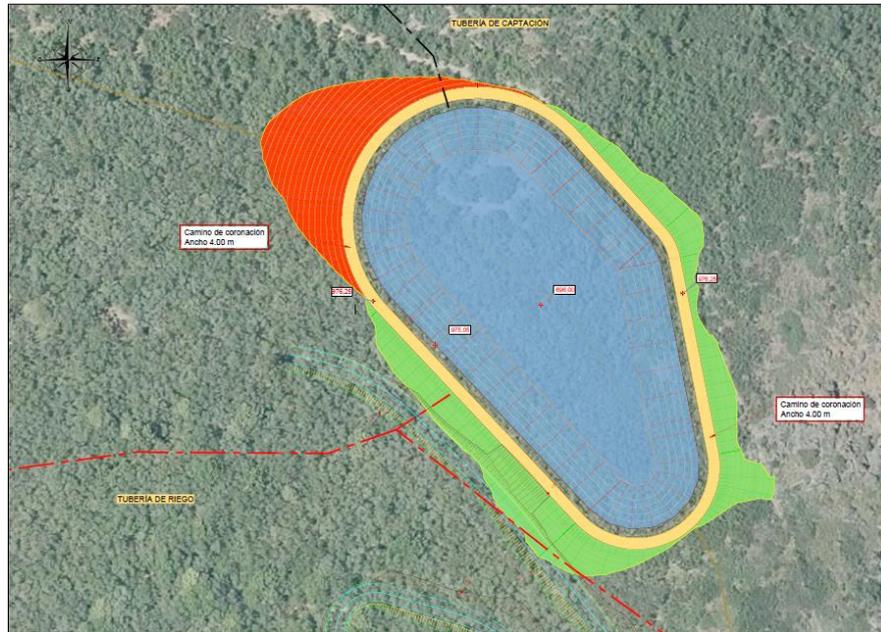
Planta de la balsa proyectada en el Sector Papúos
